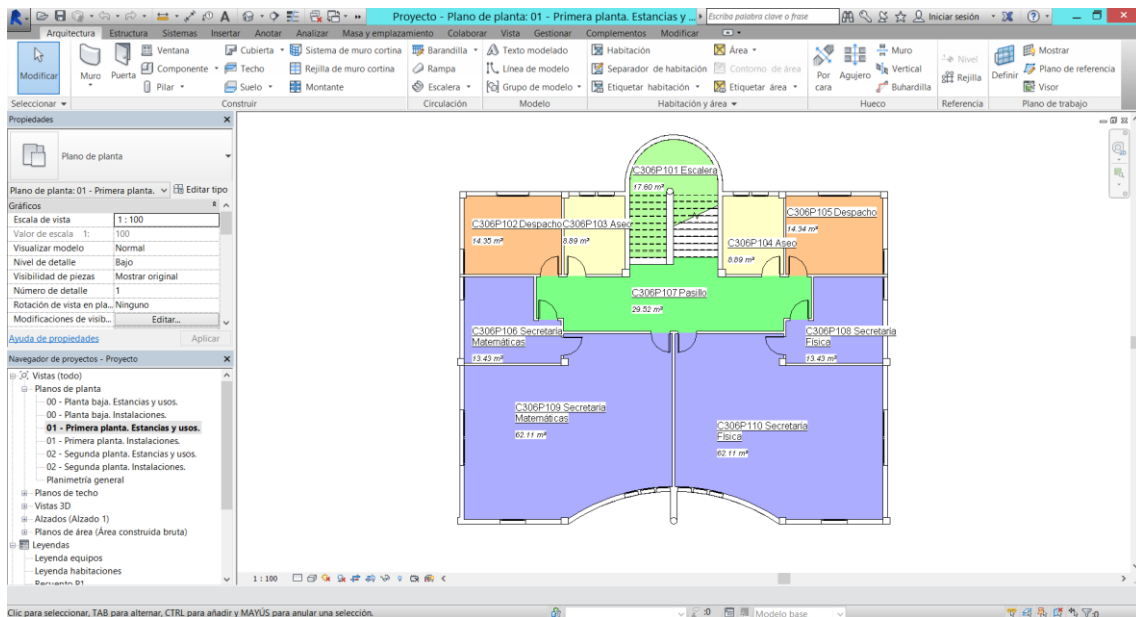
Habitaciones primera planta. Fuente: Elaboración propia
